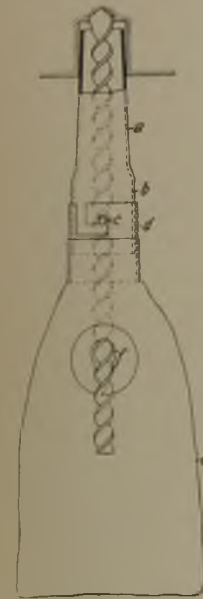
Staubfangvorrichtung für das Bohren in Aufbruchschächten.
